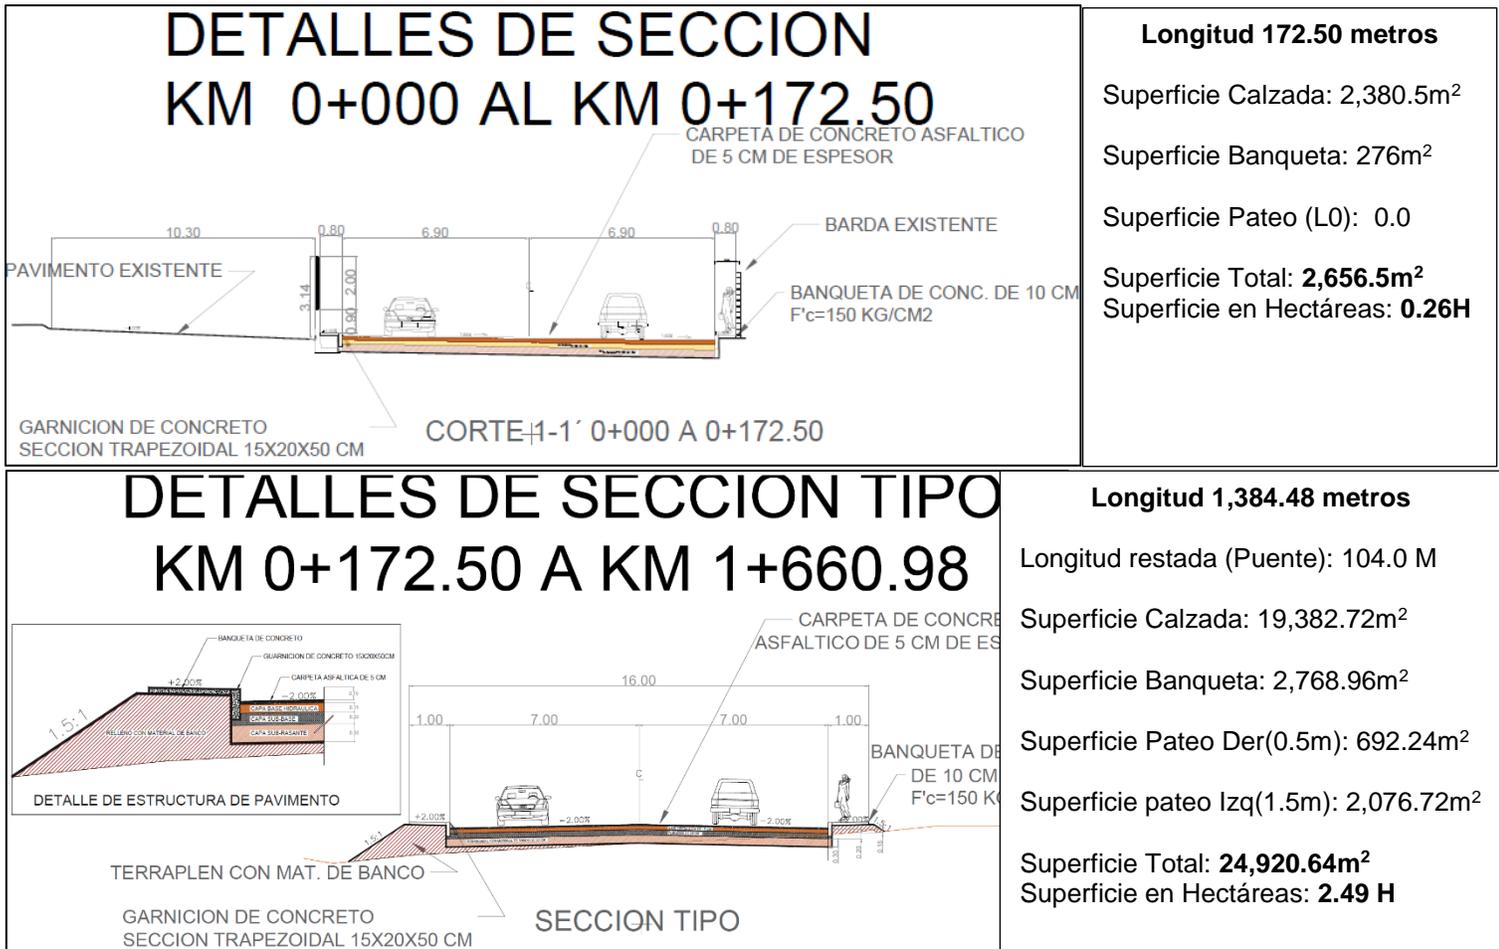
Secciones transversales del camino propuesto a pavimentar
